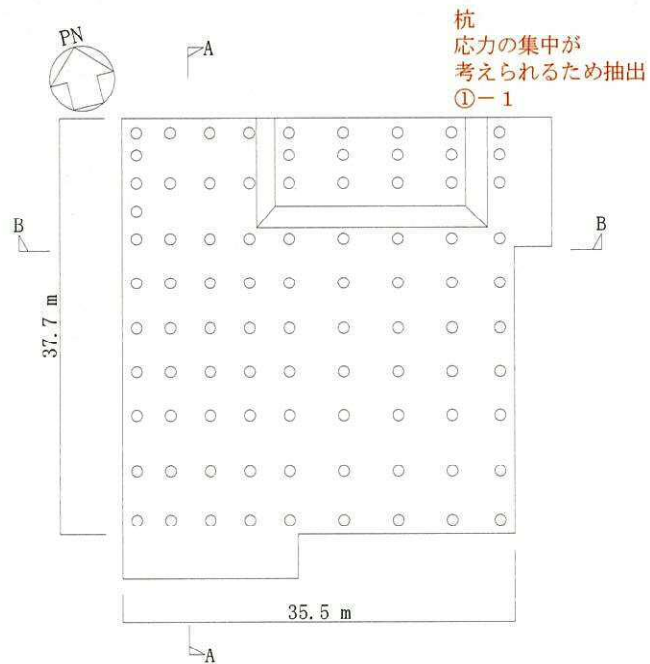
緊急時対策所建屋の概略平面図 (EL. 20.8 m)
